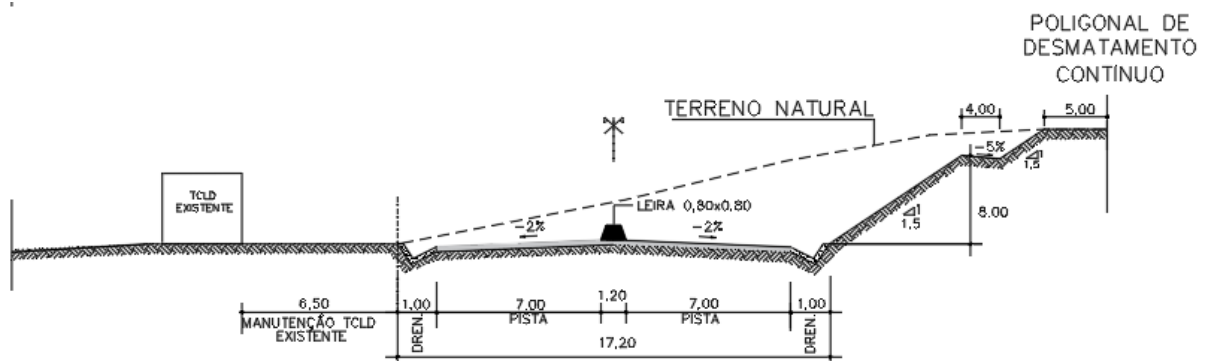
Vista da Seção Projetada da estrada – SEÇÃO DE CORTE
